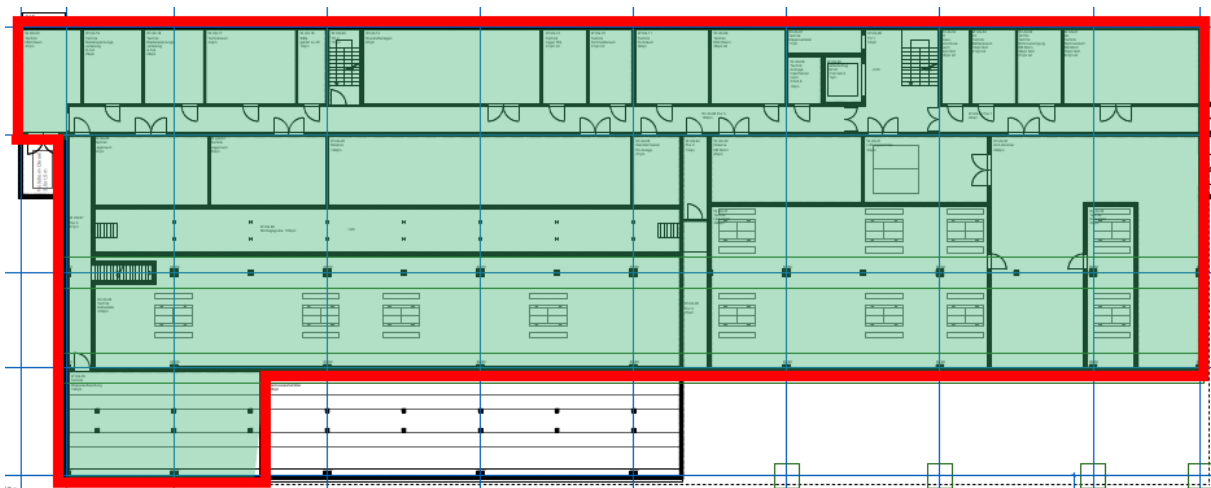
Grundriss thermische Hülle UG, Wasch-/Wartungshalle
